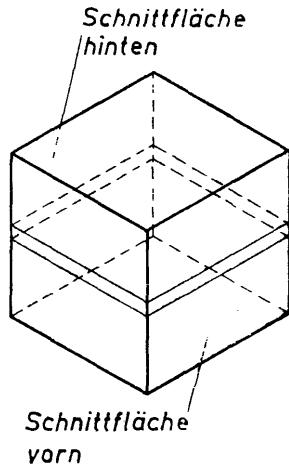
Probewürfel aus gehälfneten Vollziegeln
